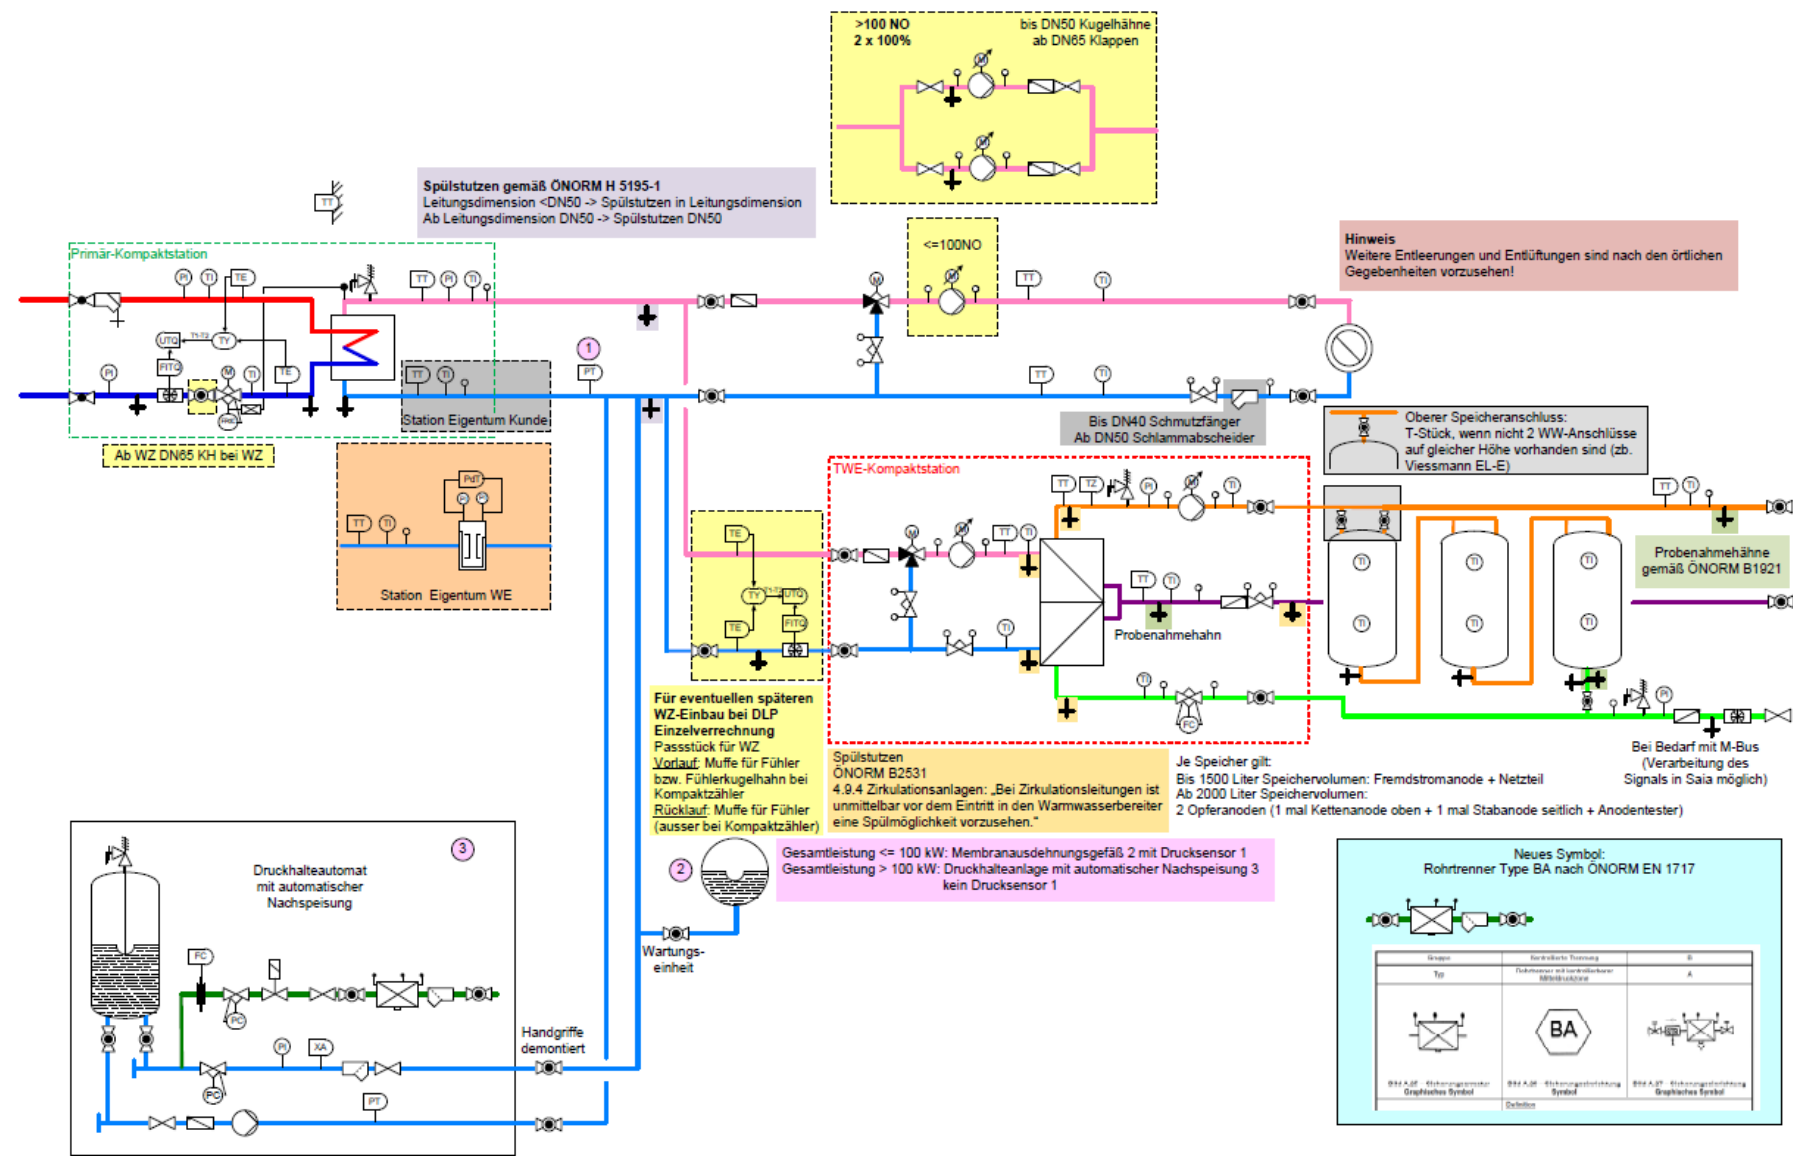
Standardschema Primäranschluss mit einer Umformerstation
